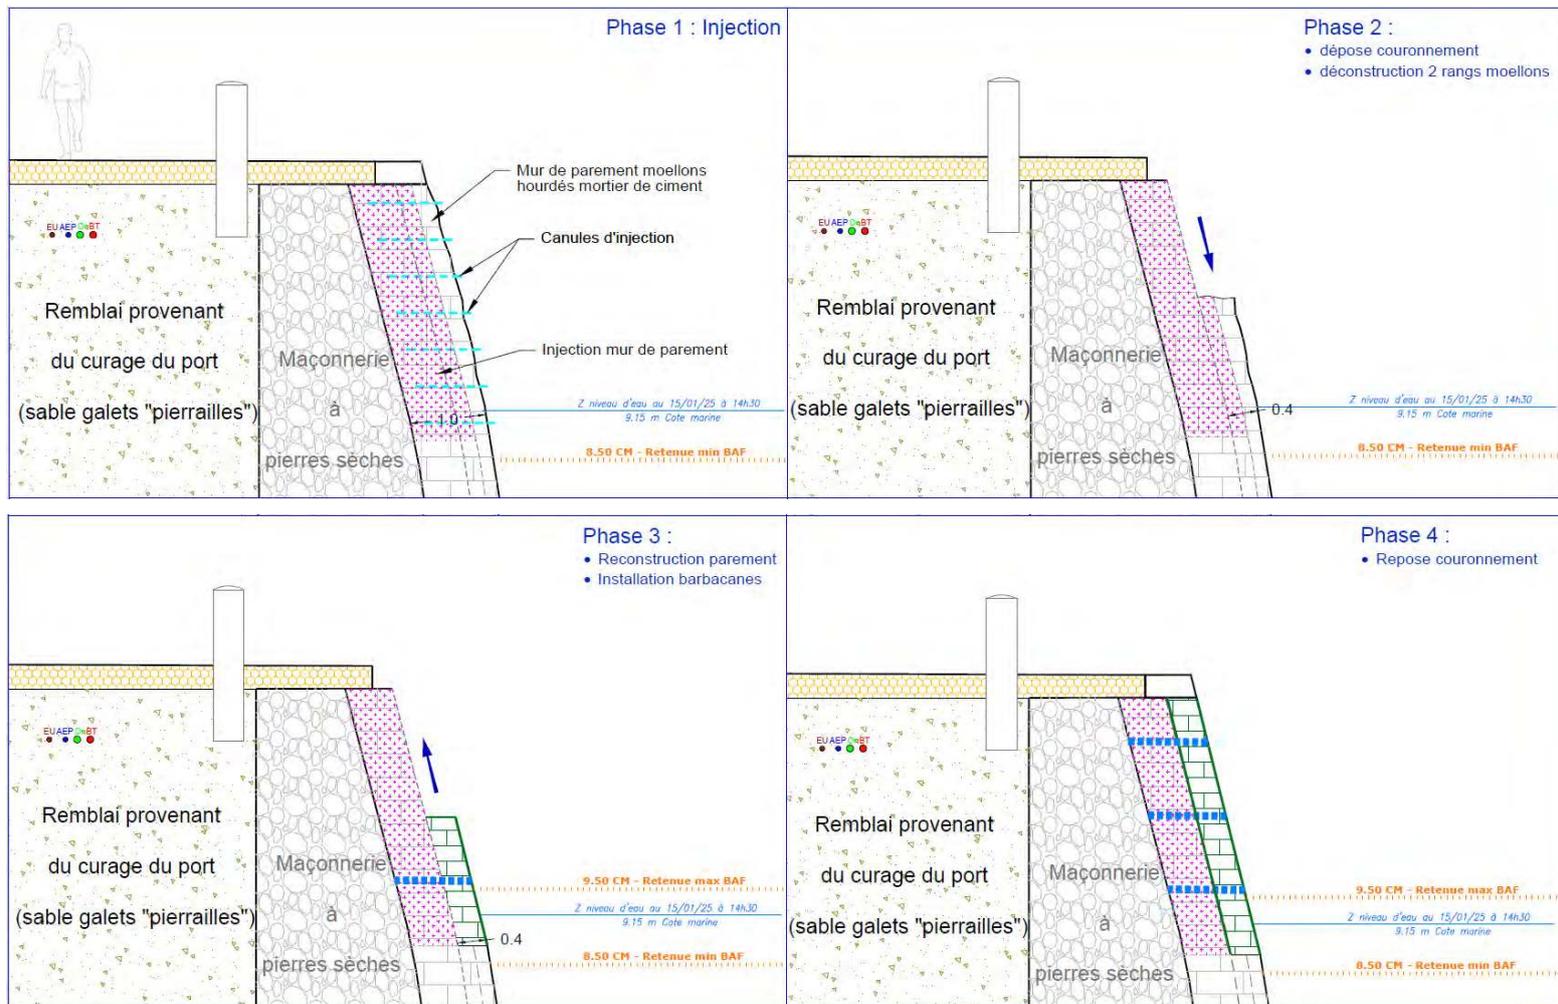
Extrait plan coupe de phasage traitement bombement murs secteur 2c.
